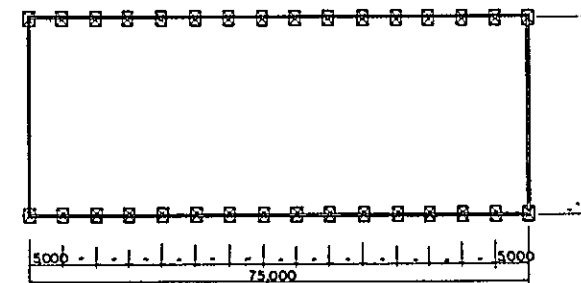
PLAN DE STRUCTURE DE MAGASIN
